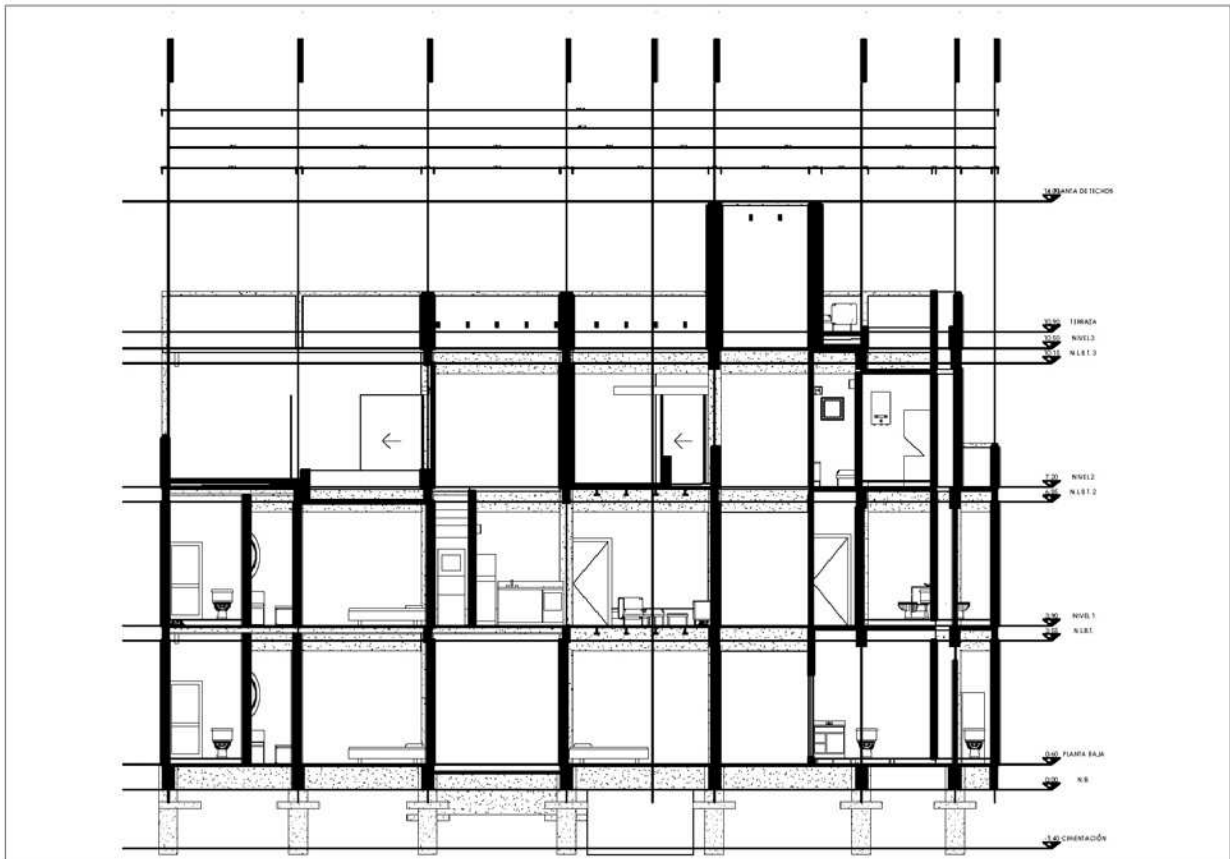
Corte transversal "B" del proyecto para la construcción de departamentos Villas Holx
